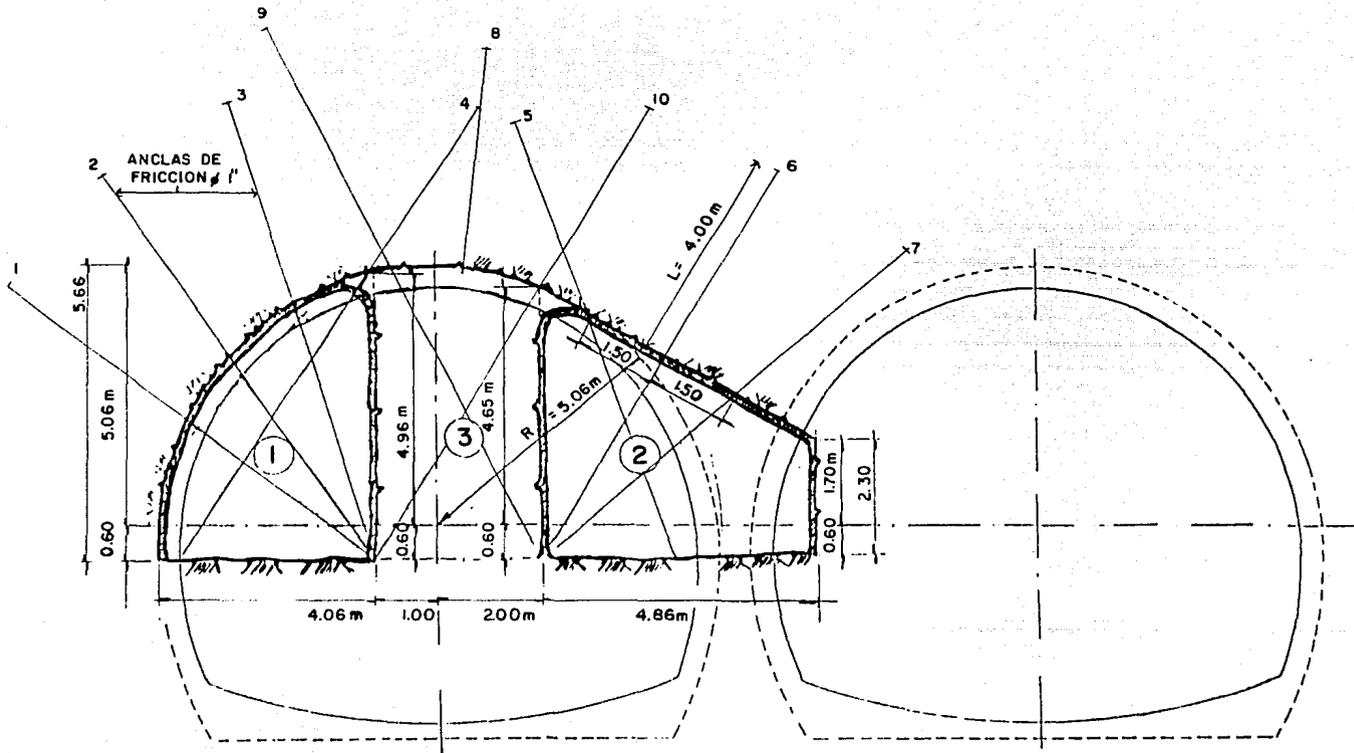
TRAMOS DE EMBOQUILLADOS Y TRANSICION
